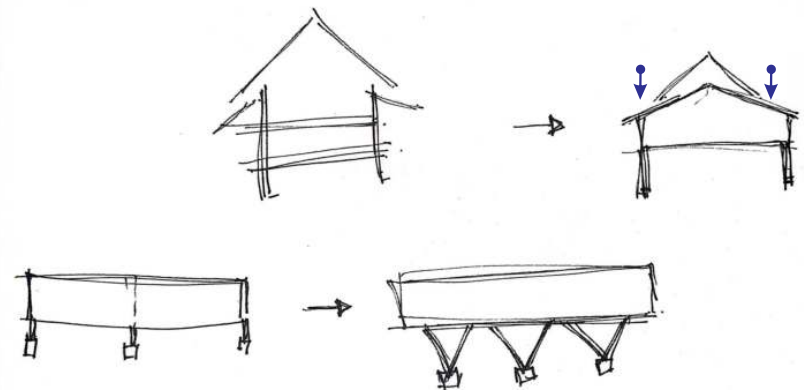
Eksplorasi Bentuk Bangunan Hotel
